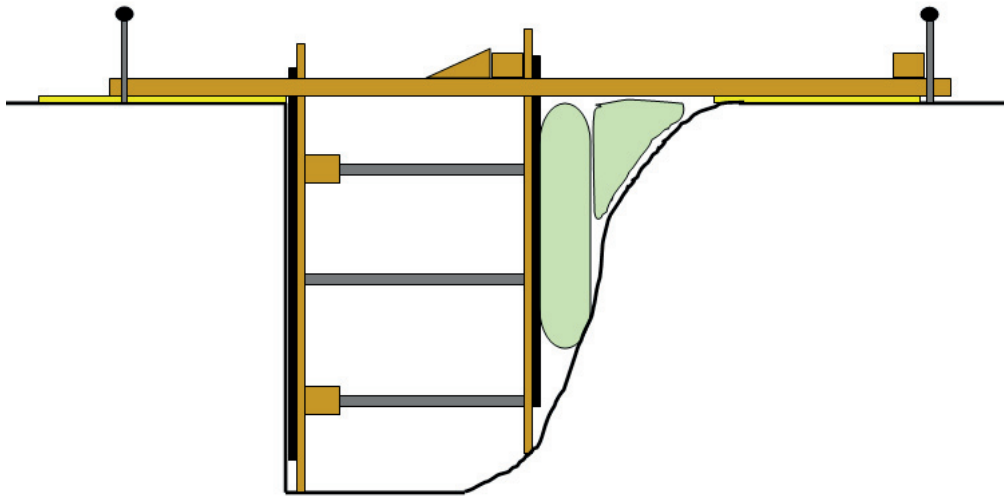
, Základní stabilizace výkopu tvaru "T" [7]
